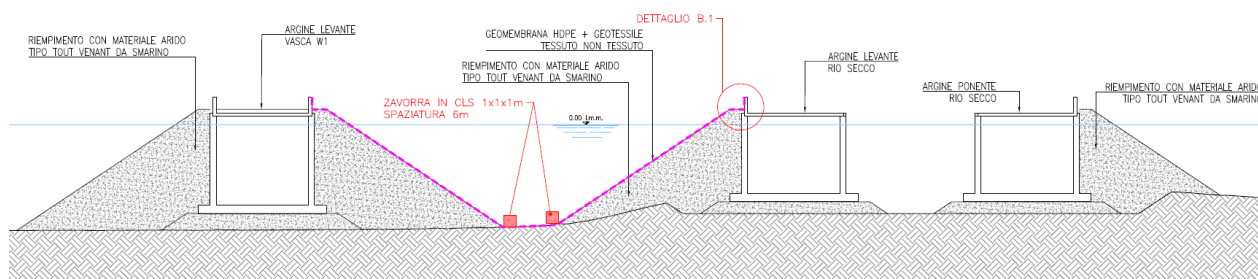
Sezione impermeabilizzazione della vasca W1
